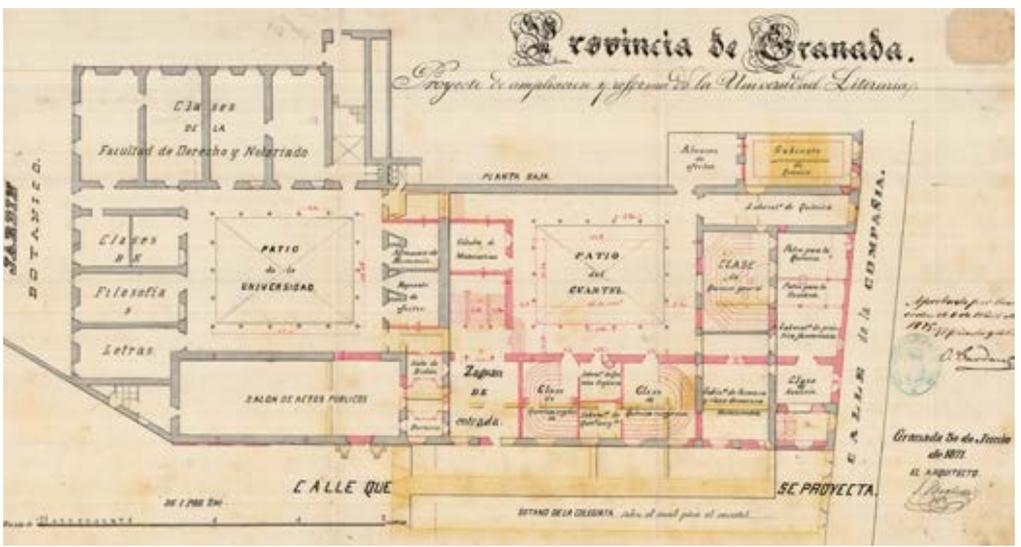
Santiago Baglietto, Proyecto de ampliación y reforma de la Universidad de Granada, planta baja, 1871, AGA.
